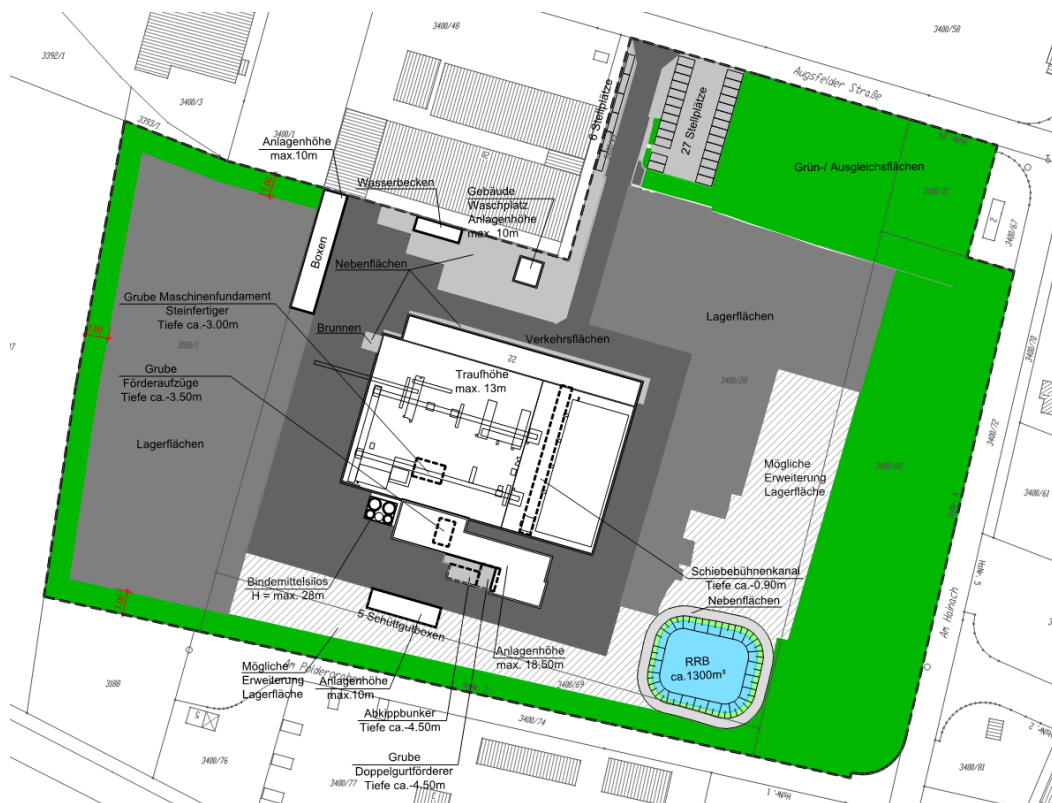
Vorhaben- und Erschließungsplan „Umbau Betonwerk Haßfurt“, Stand 19.04.2018.
